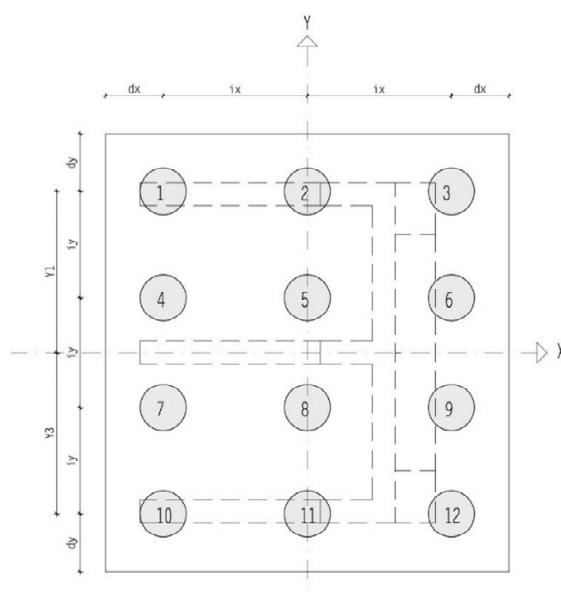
Disposizione pali su spalla sinistra
